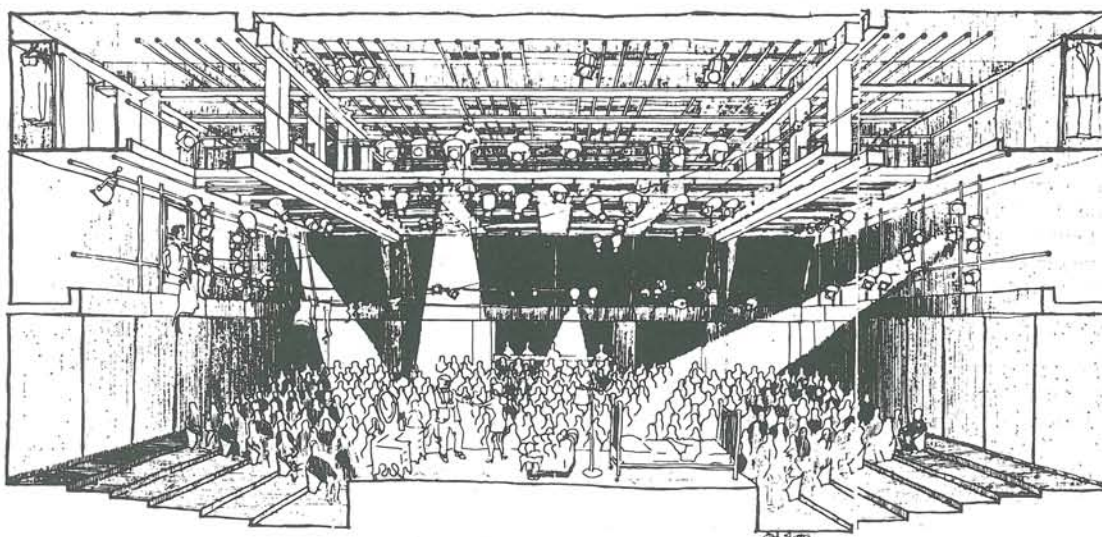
America Place Theater. New York (R. D. Kaplan, 1970).
